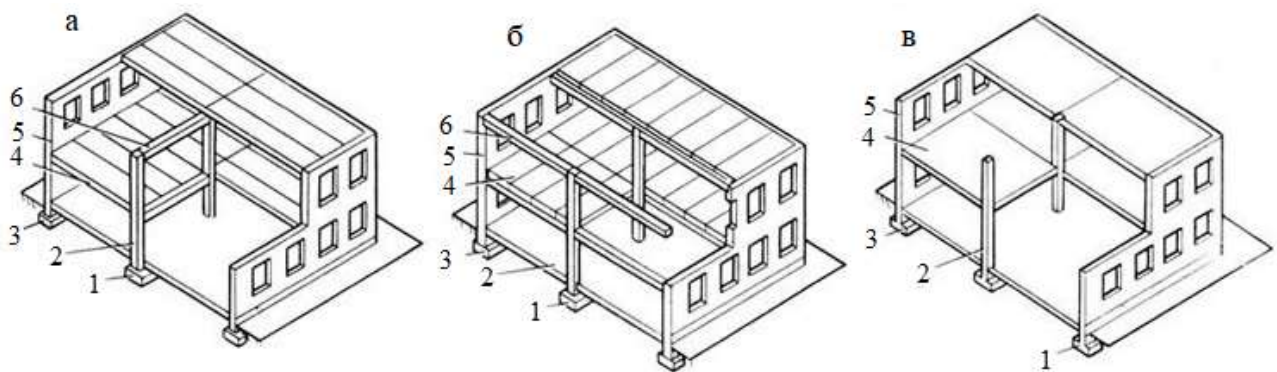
Конструктивні схеми будівель з неповним каркасом: а – з поздовжнім розташуванням ригелів; б – з поперечним розташуванням ригелів; в – безригельне рішення; 1 – стовпчастий фундамент; 2 – колона; 3 – стрічковий фундамент; 4 – панель міжповерхового перекриття; 5 – несуча кам'яна стіна; 6 – ригелі
